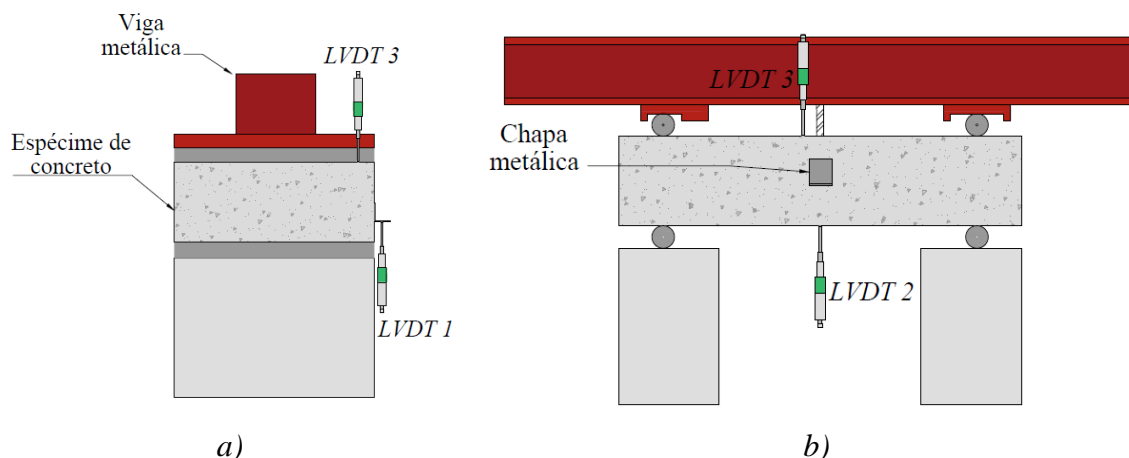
Disposição dos *LVDTs* para leitura de deslocamentos do conector metálico: a) Vista lateral do sistema de ensaio; b) Vista frontal do sistema de ensaio
